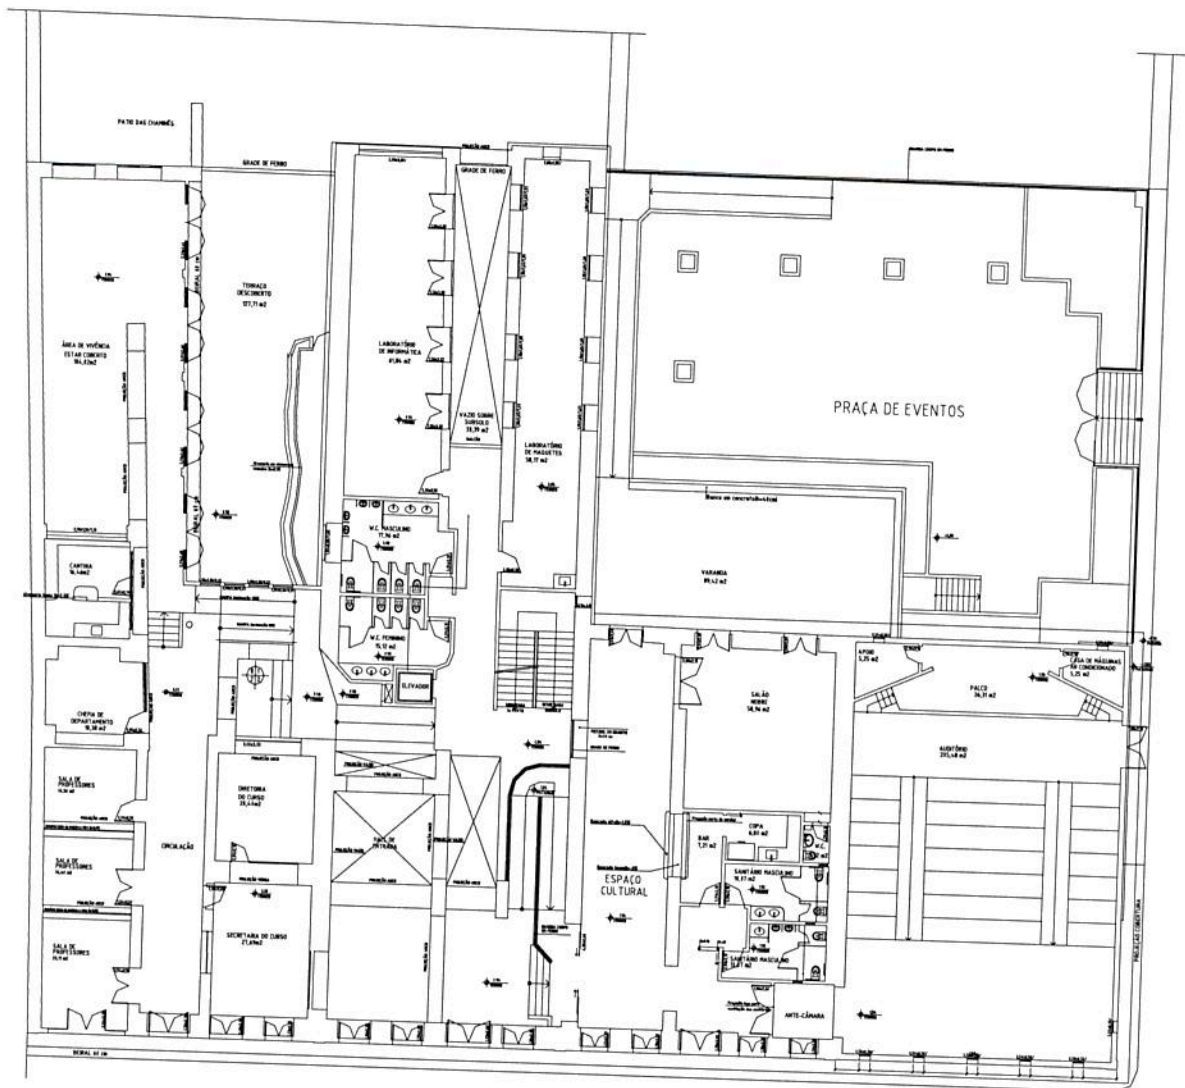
Planta Baixa – Subsolo (Sem Escala)
